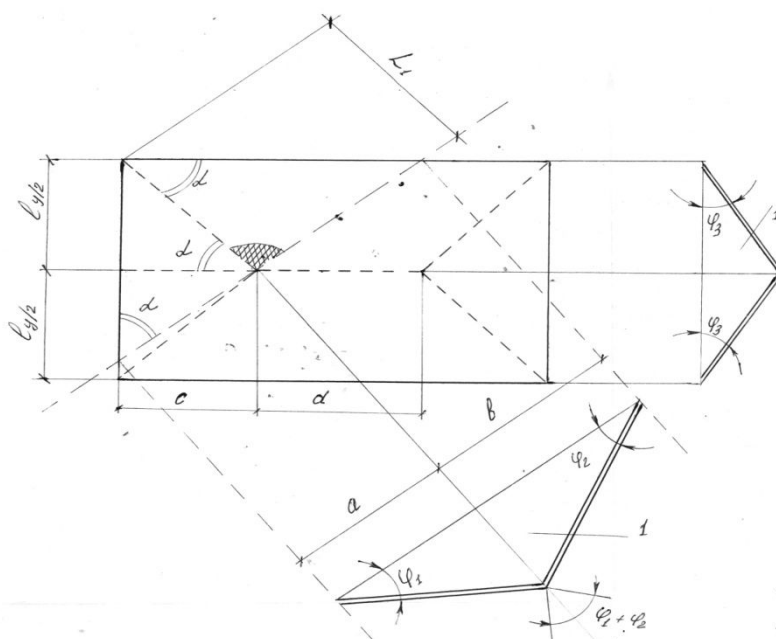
Расчетная схема излома сборных железобетонных плит перекрытий методом предельного равновесия
